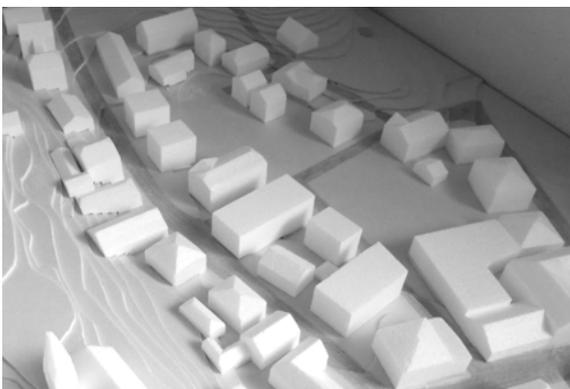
Verdichtungspotenziale, Variantenstudien im Teilgebiete „UeO Kirchgasse“ und „Alleestrasse“
